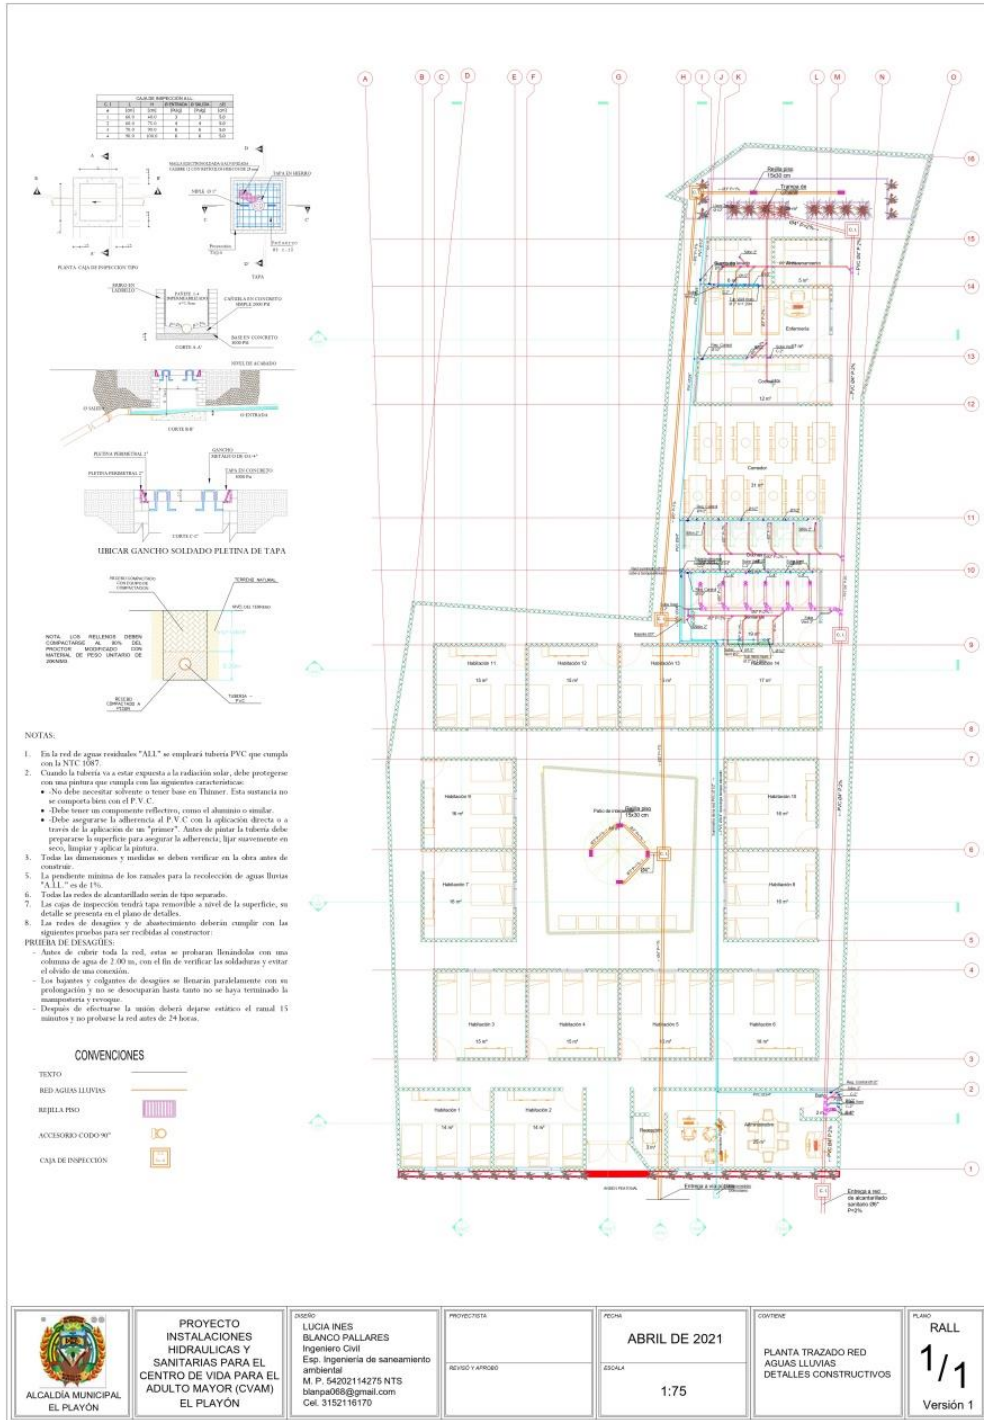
Planta Trazado Red Aguas Lluvias, detalles constructivos
